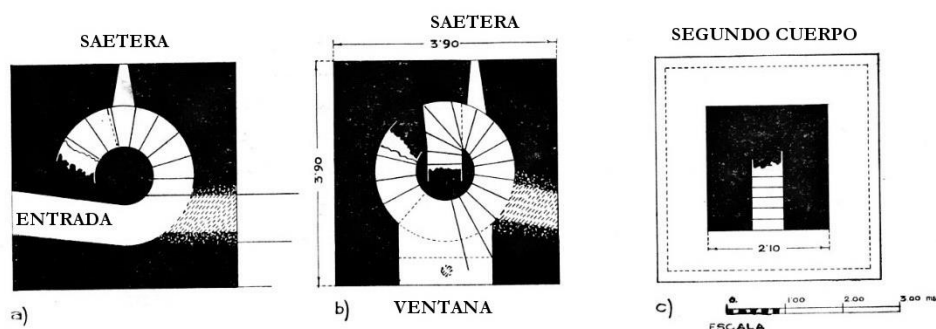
a) Planta inferior, b) Planta a nivel de ventana, c) Planta terminal de la escalera.
